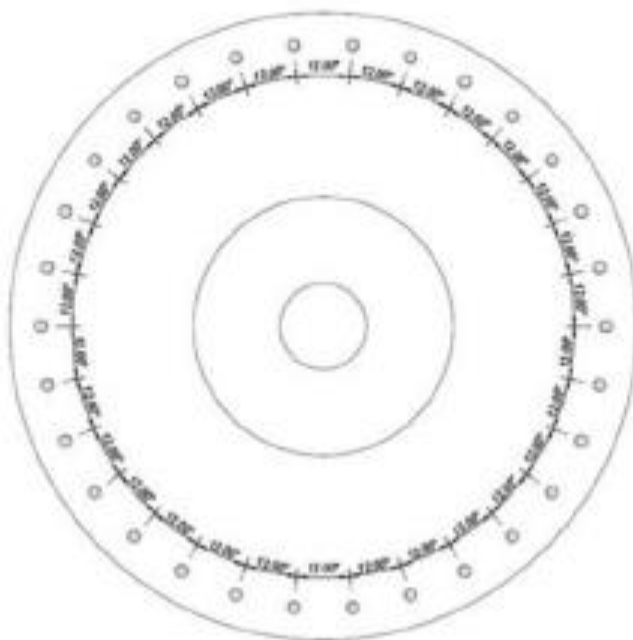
Andamento geometrico della fondazione (pianta – non in scala).
